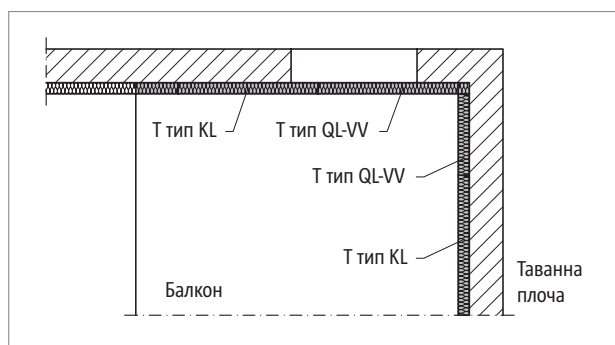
Schöck Isokorb® T mun KL: Конзолен балкон
